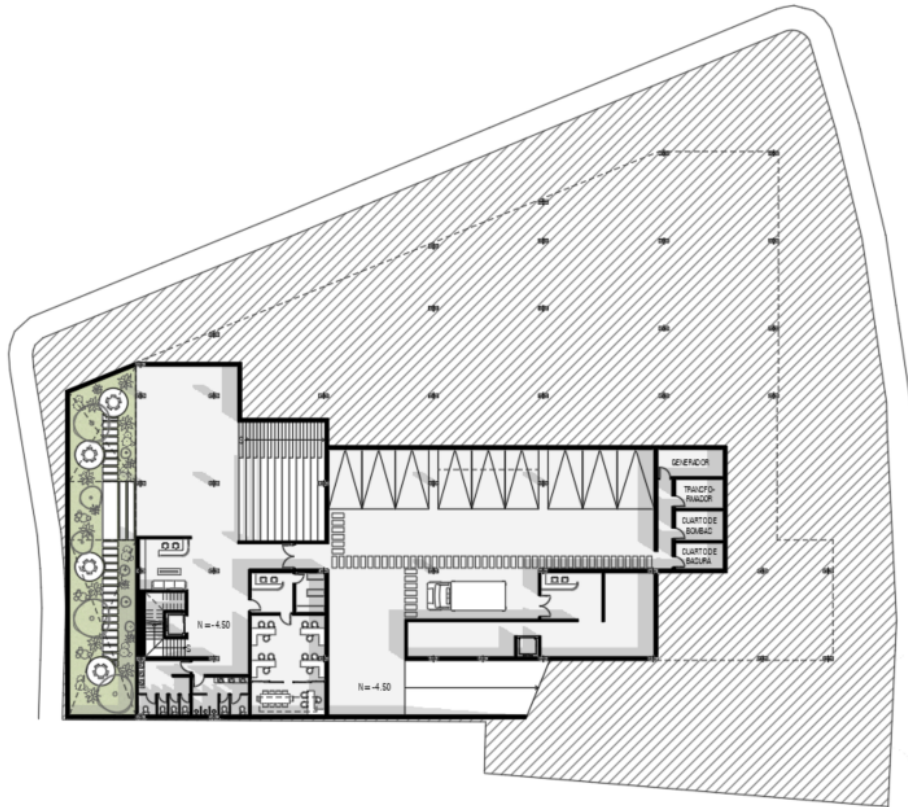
Planta subsuelo - Proyecto definitivo. Elaboración propia.
